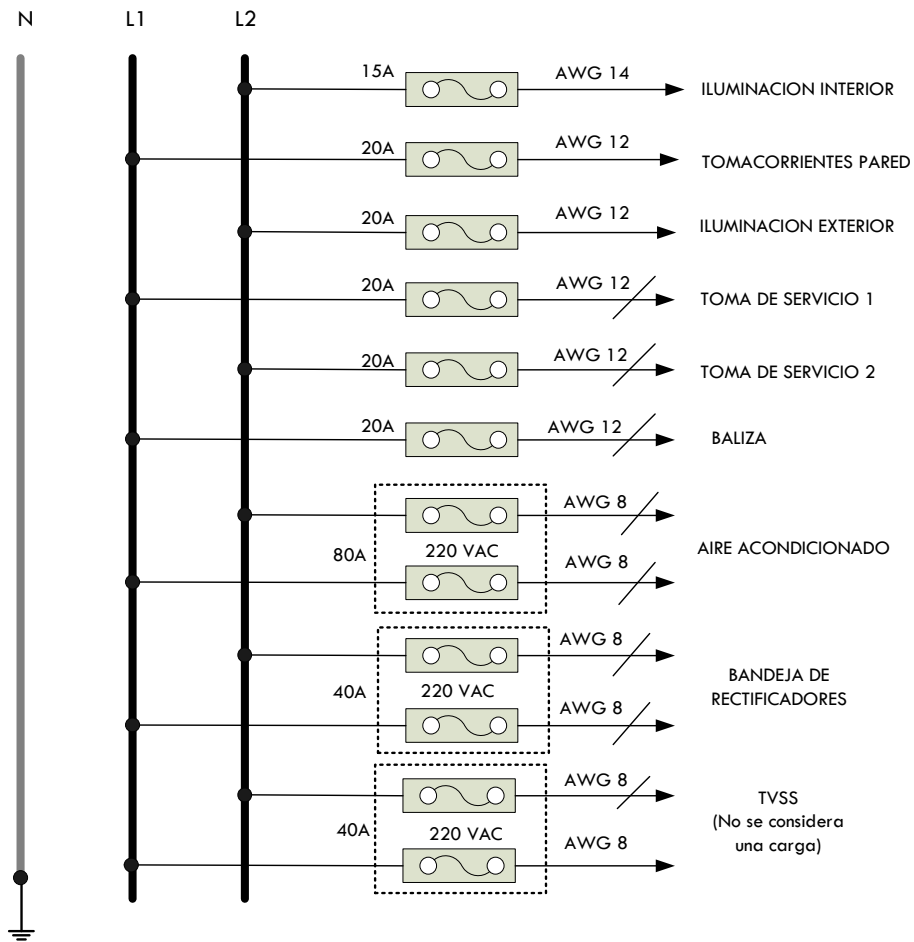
Diagrama unifilar eléctrico con cargas de corriente alterna
